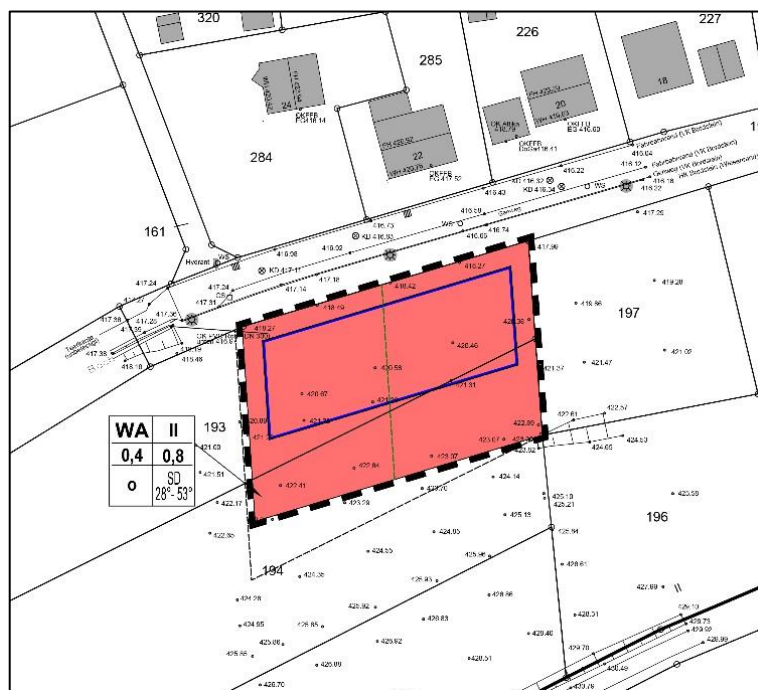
Übersicht Planung/Entwurf (Quelle: Planzeichnung /Ausschnitt verkleinert)
